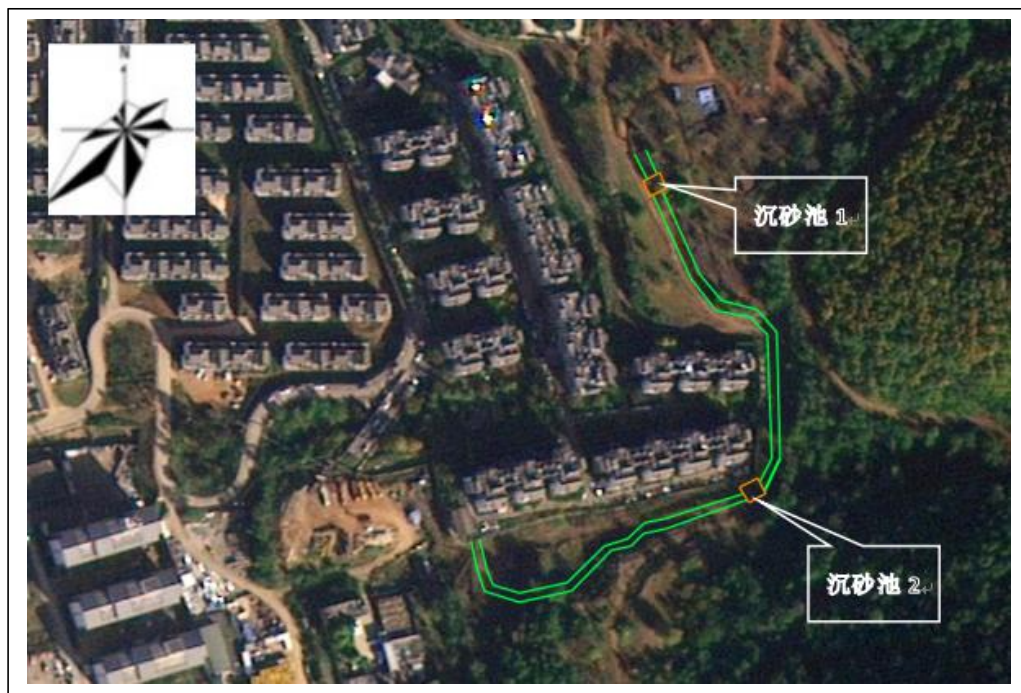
玉器城东侧截洪沟和沉砂池平面布置图
